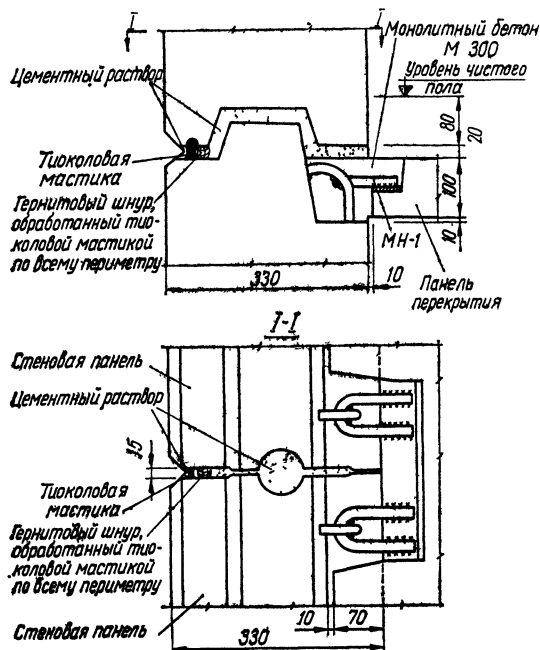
Деталь узла, в котором сходятся панели наружной продольной стены, поперечной стены и перекрытия.
